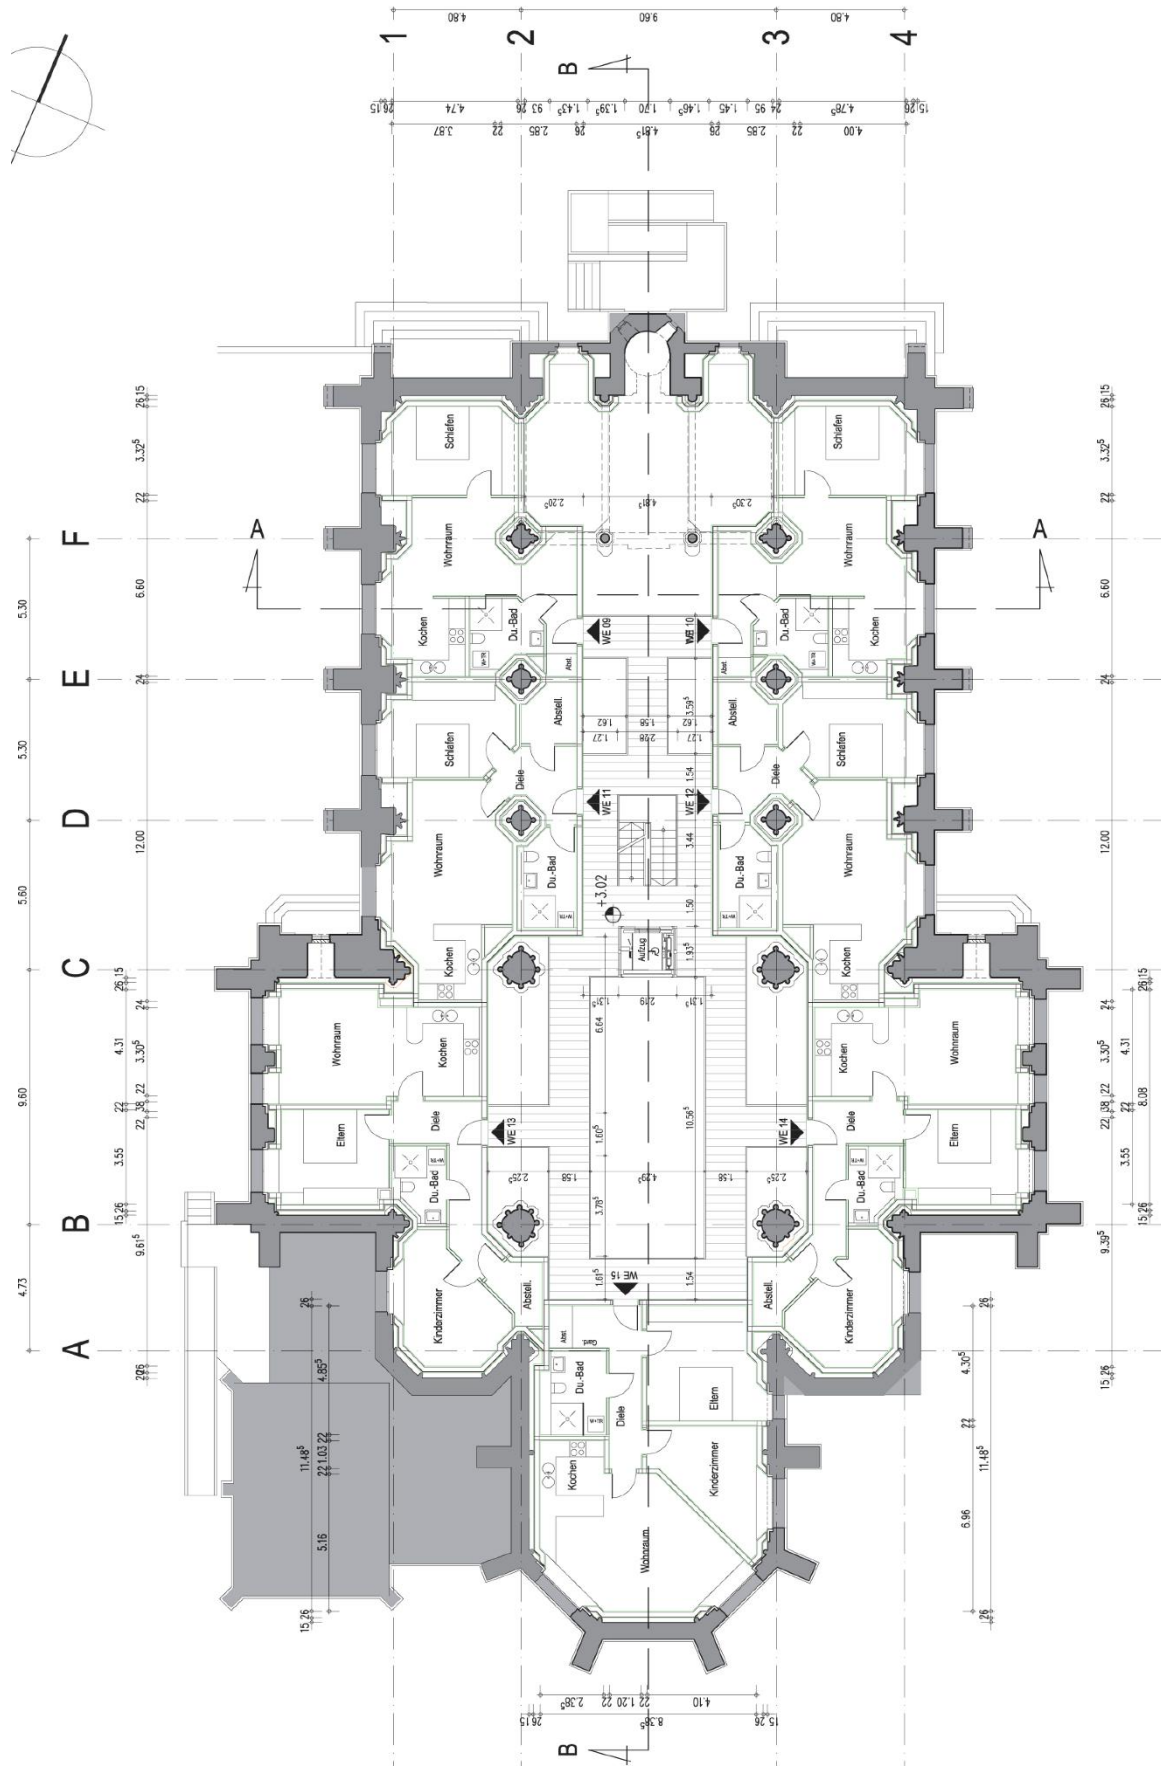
Grundriss 1.Obergeschoss
